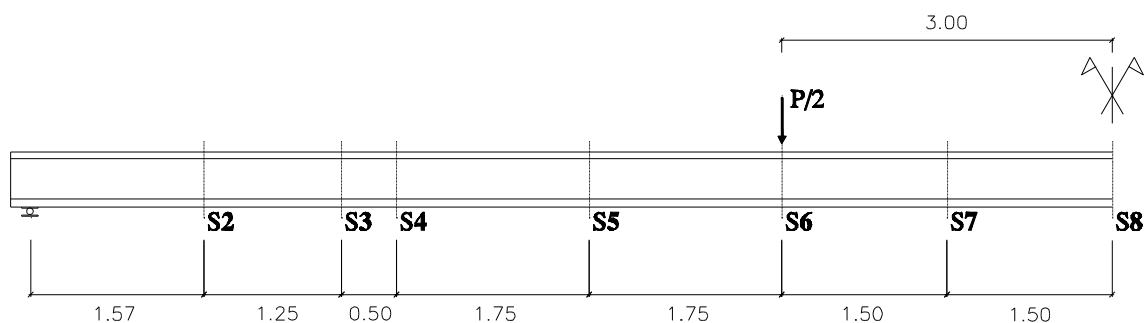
Secções instrumentadas para monitorização da viga (dimensões em m).
